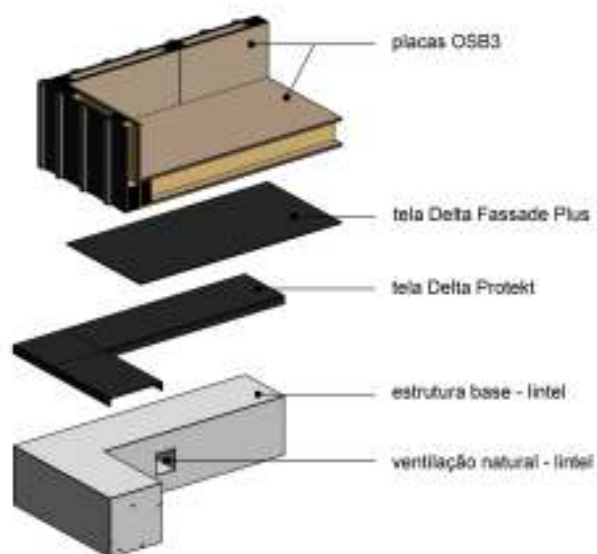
Pormenor construtivo da impermeabilização da laje de pavimento e da viga de fundação.
